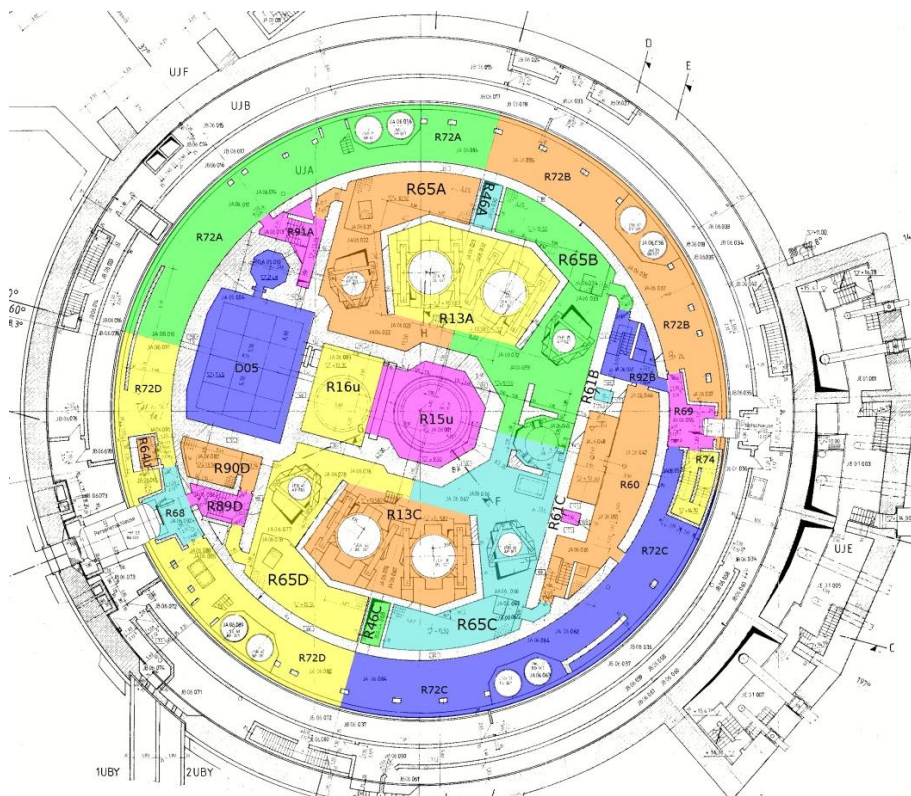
Schnitt durch den SHB bei +12 m (Höhenkote +14,2 m)
